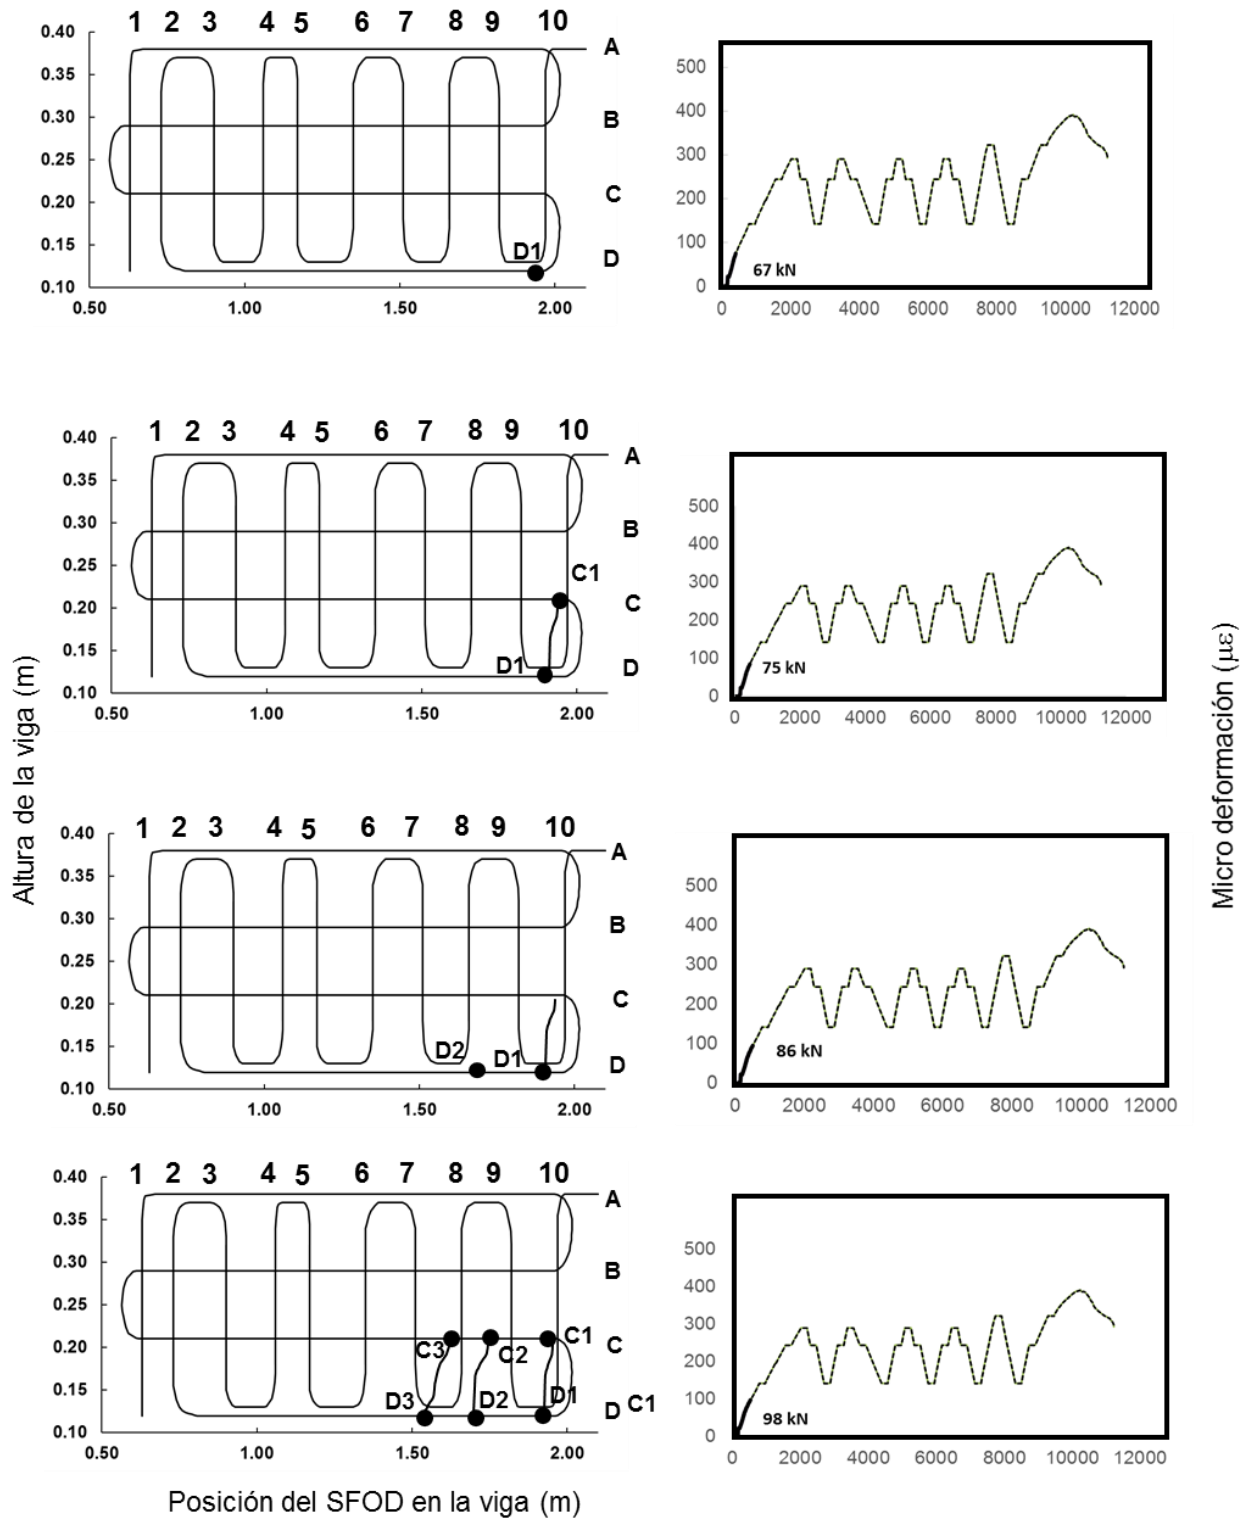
Patrones de fisuración de la viga I-2 (67 a 98 kN)
